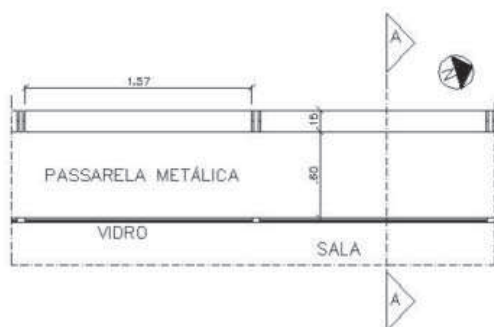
Planta baixa com representação do brise horizontal, afastado 60 cm da fachada
